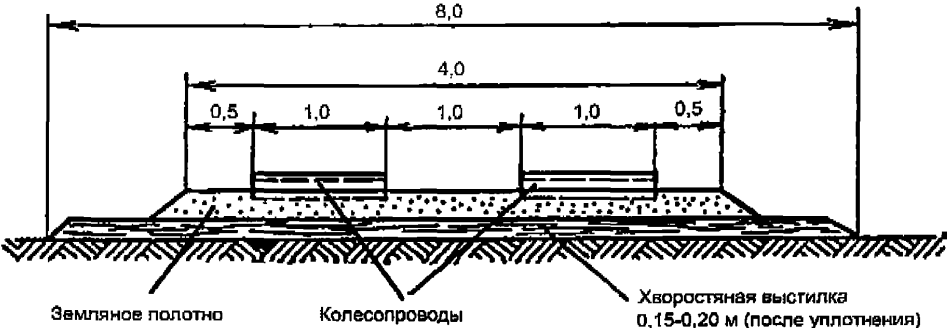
Поперечный профиль лесных дорог из железобетонных плит для условий типа местности III со слабыми грунтами, не пригодными для укладки в земляное полотно
